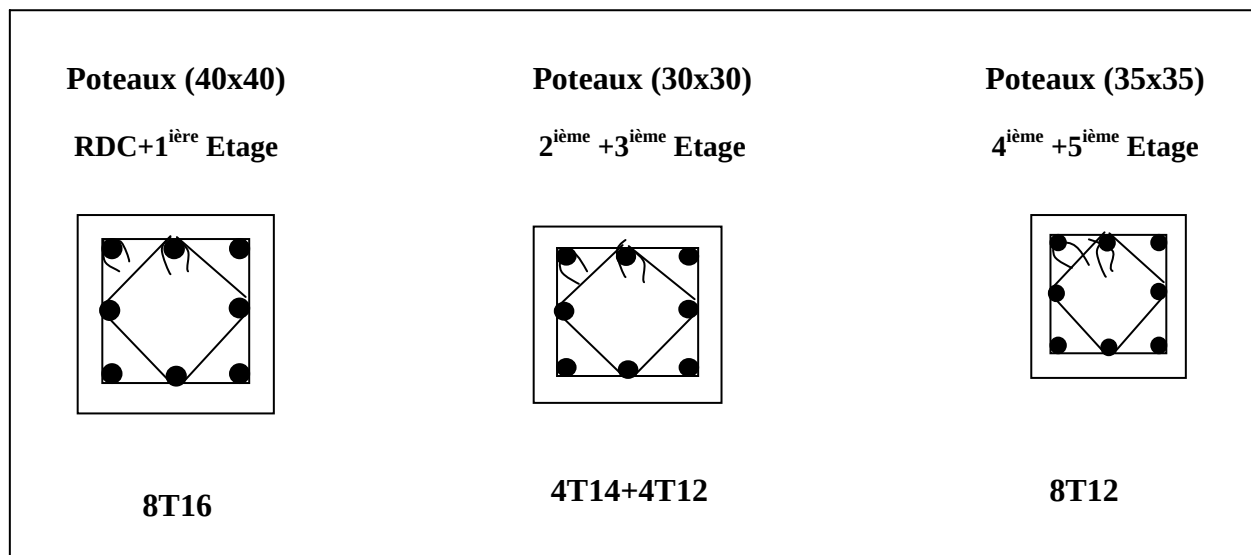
Dessin de ferrailages des sections des poteaux
